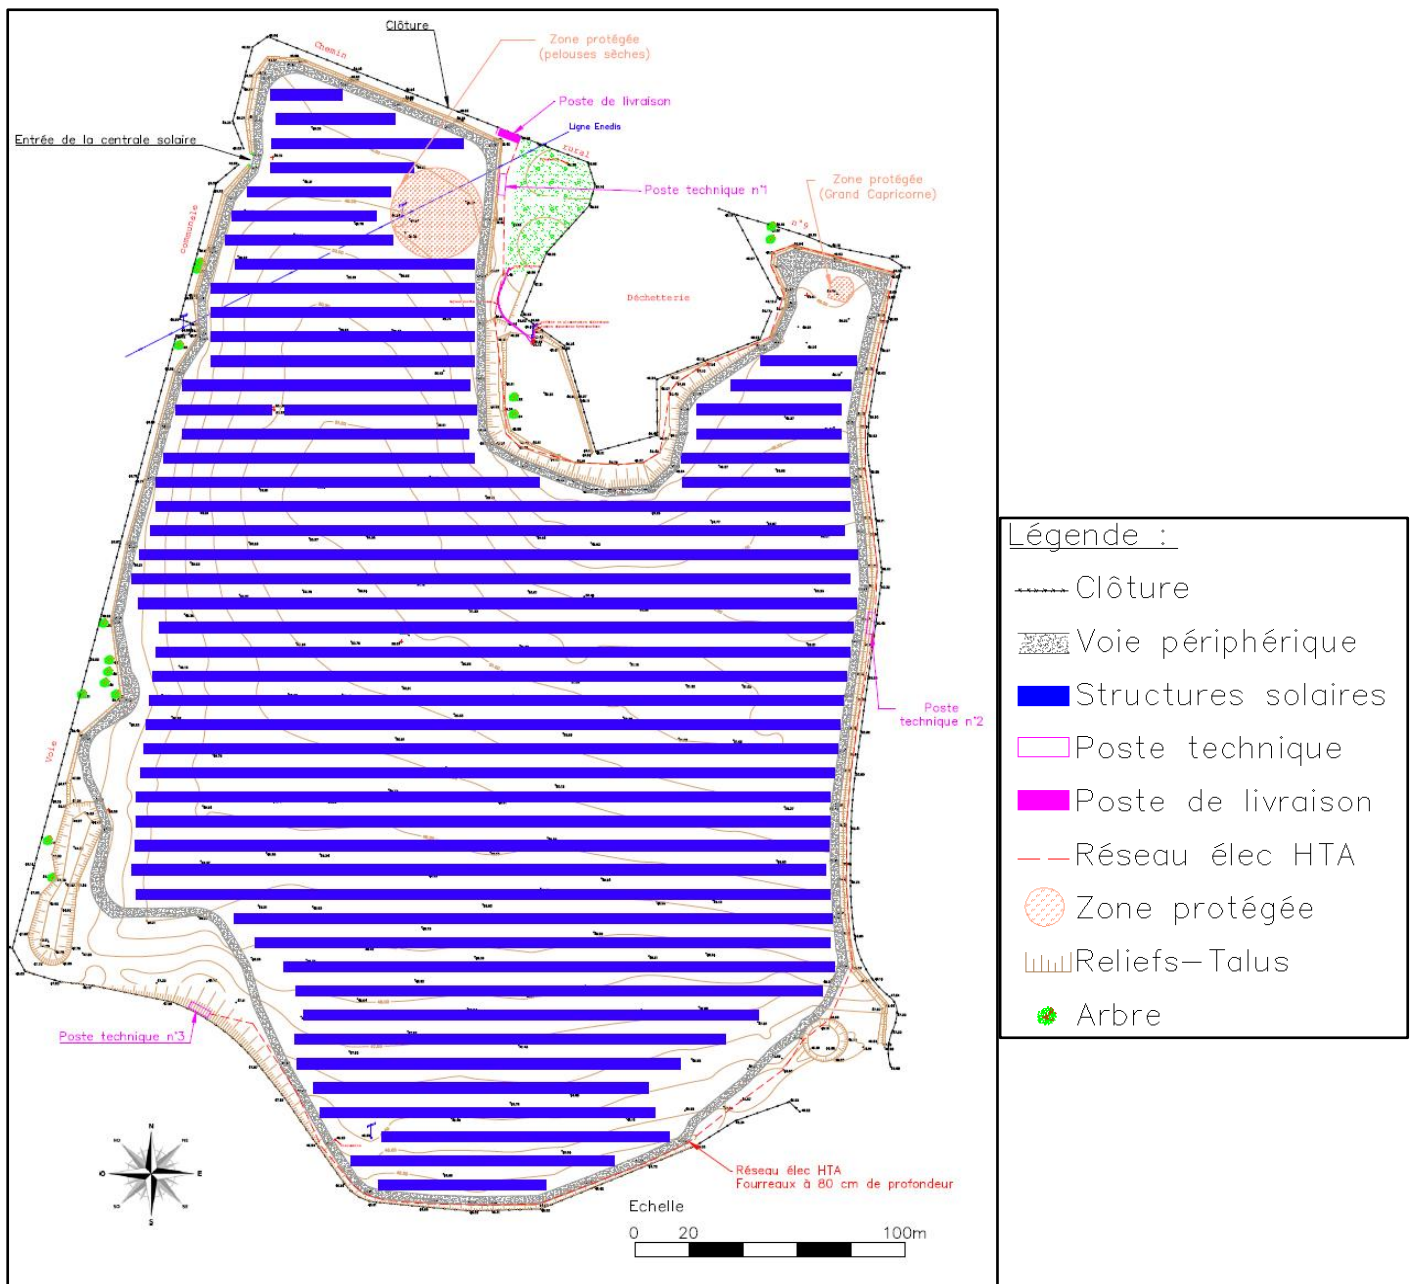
Plan d'implantation général définitif (Source : IEL)
